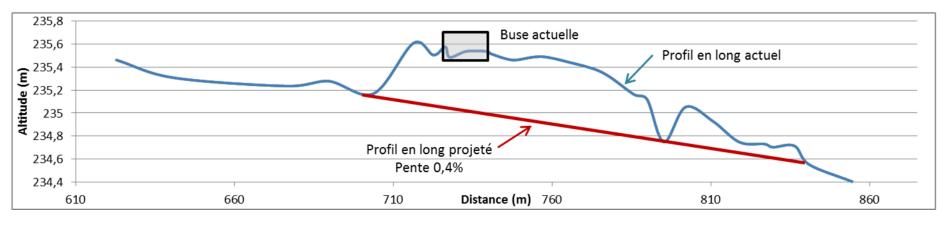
Profil en long du Steinbach au droit de l'ouvrage de la rue Wittberg
